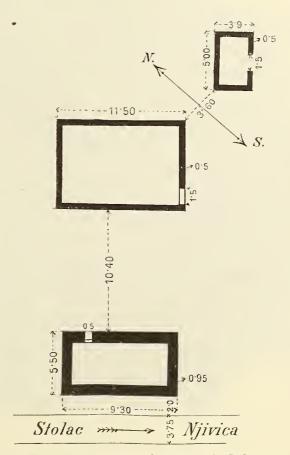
Grundriss römischer Ruinen in Stolae.
